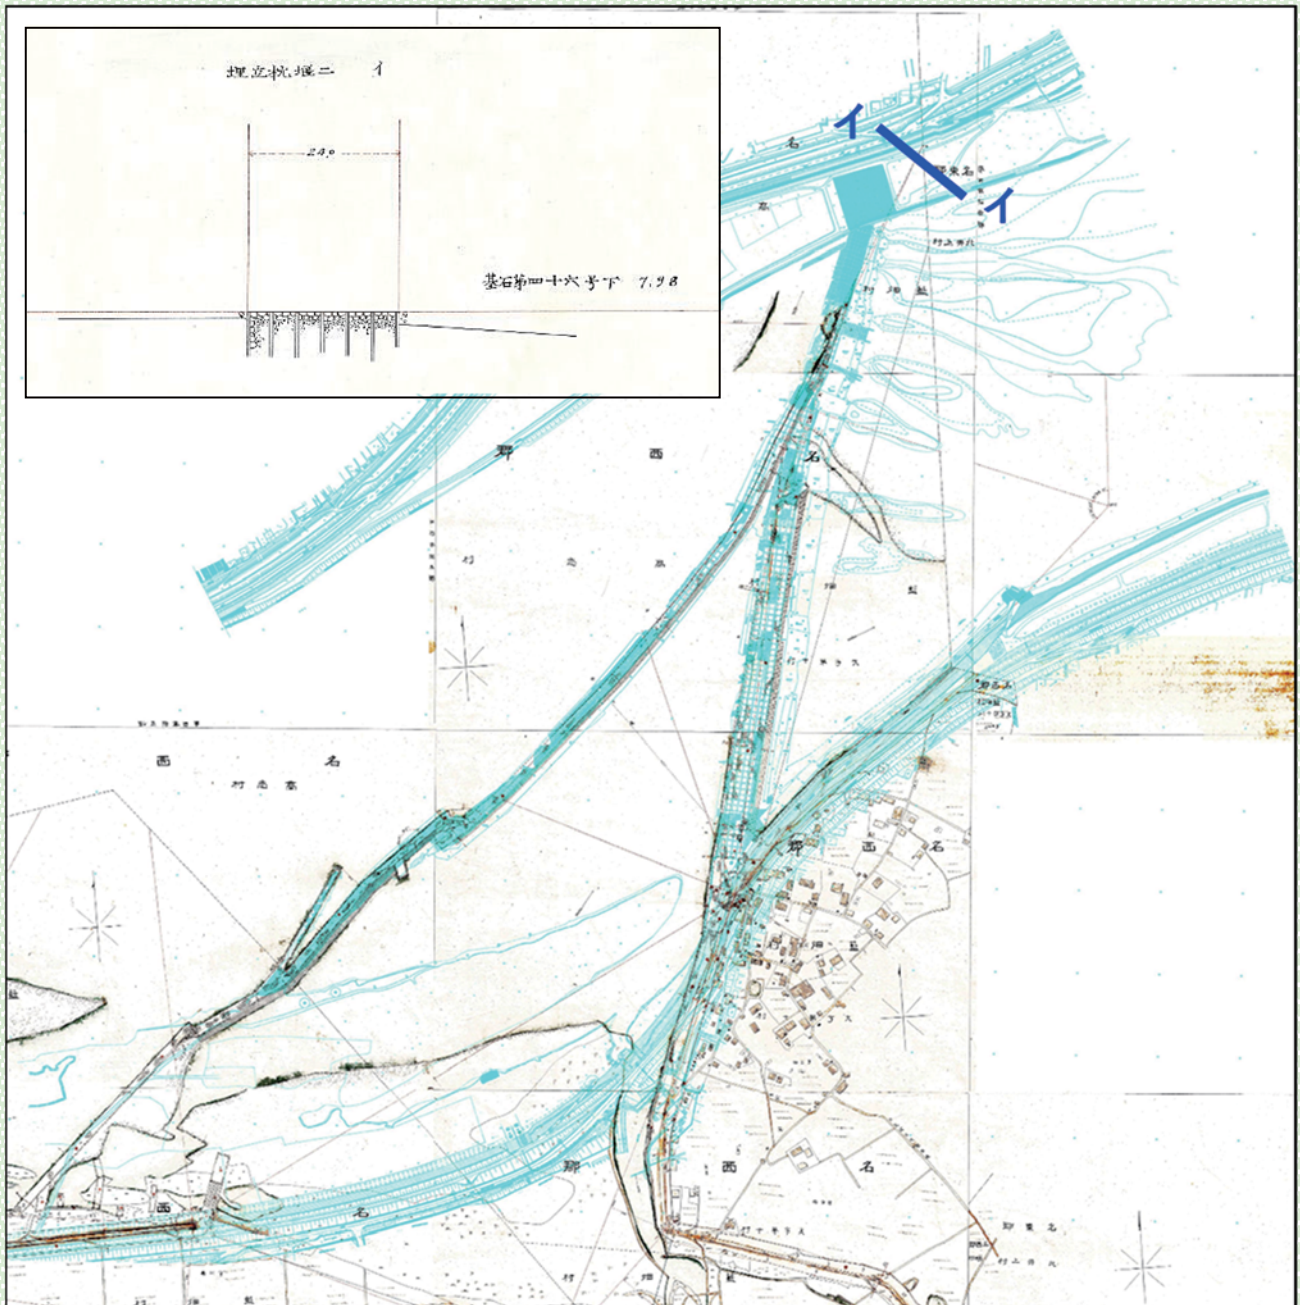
吉野川台帳平面図 現在の地形図(水色)との重ね図
